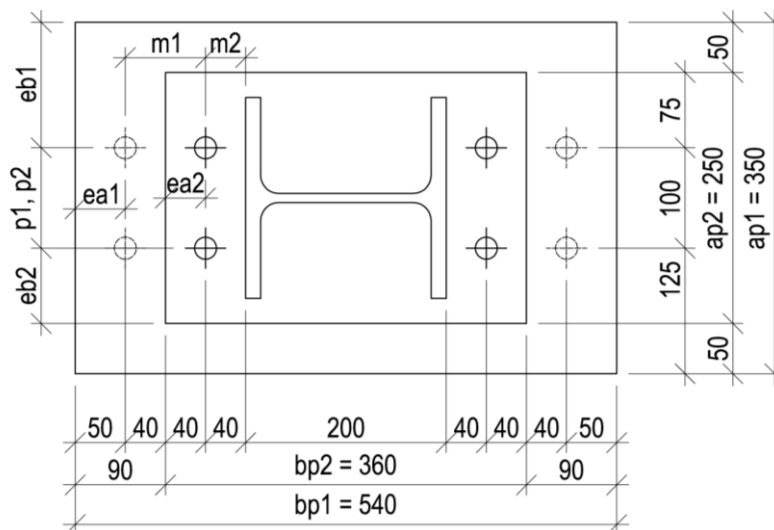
Grundriss der Stützenfußplatte mit Ankerplatte
